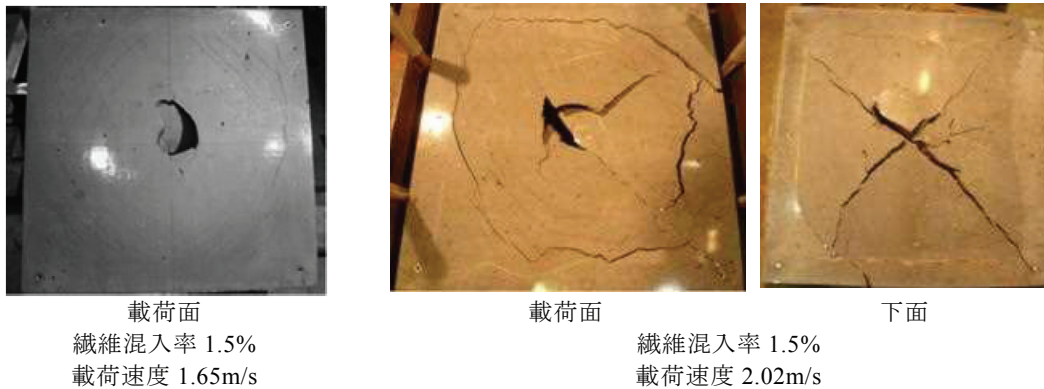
繰返し衝撃載荷後のひび割れ発生状況 [10]
